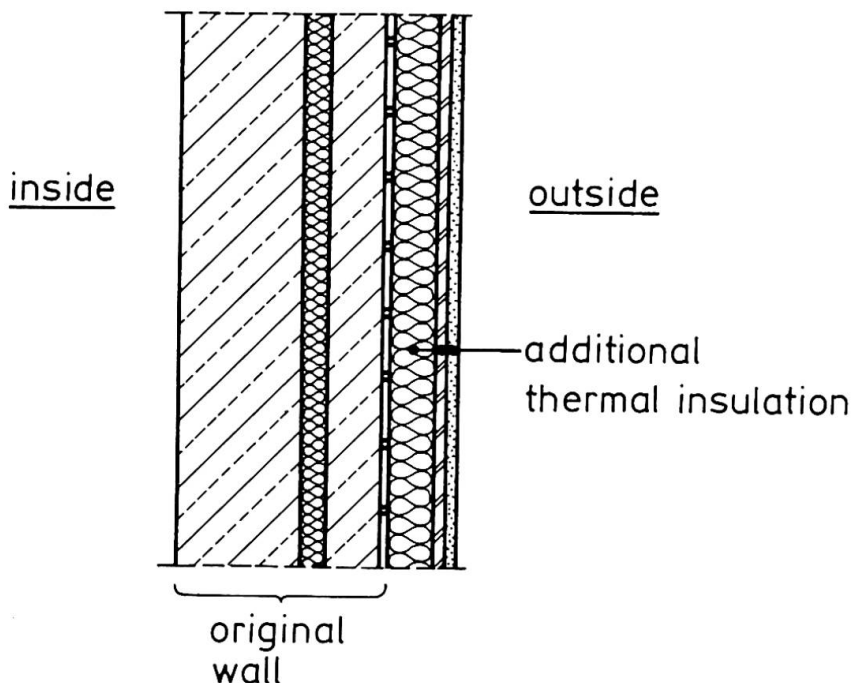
Sanierung der korrodierten Bewehrung durch nachträgliches Aufbringen einer Wärmedämmung
